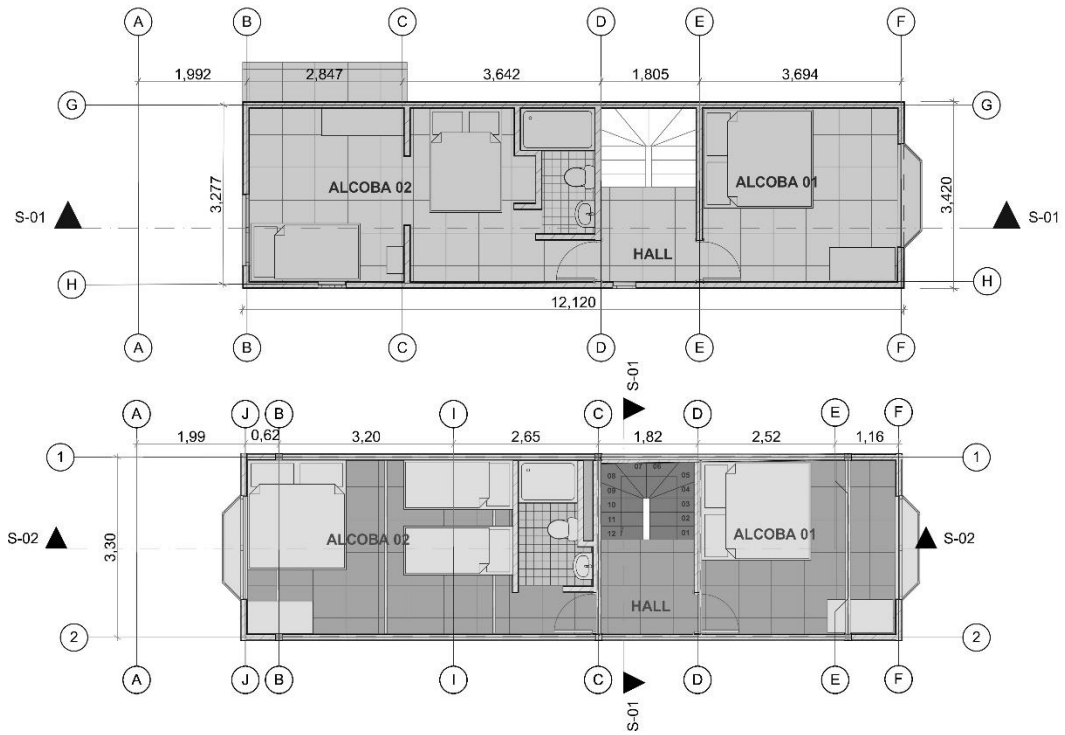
Plantas de segundo piso existente y propuesta, indicando nueva espacialidad. Elaboración propia 2017.
